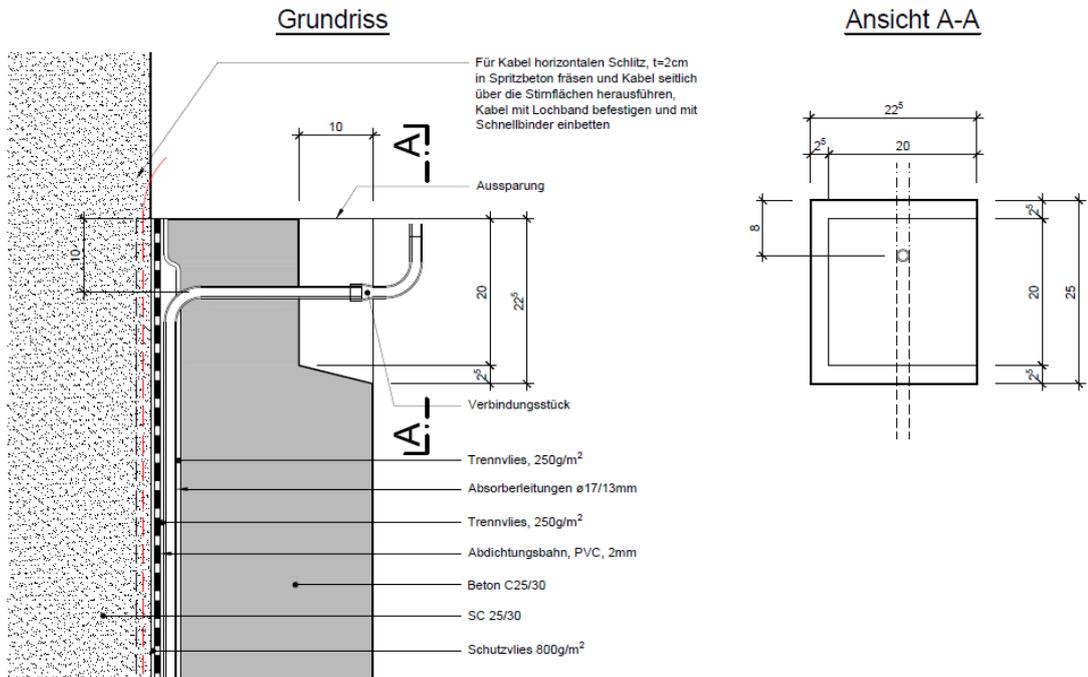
Leitungsdurchführung in Aussparung [Auszug aus Plan Anhang A1]
